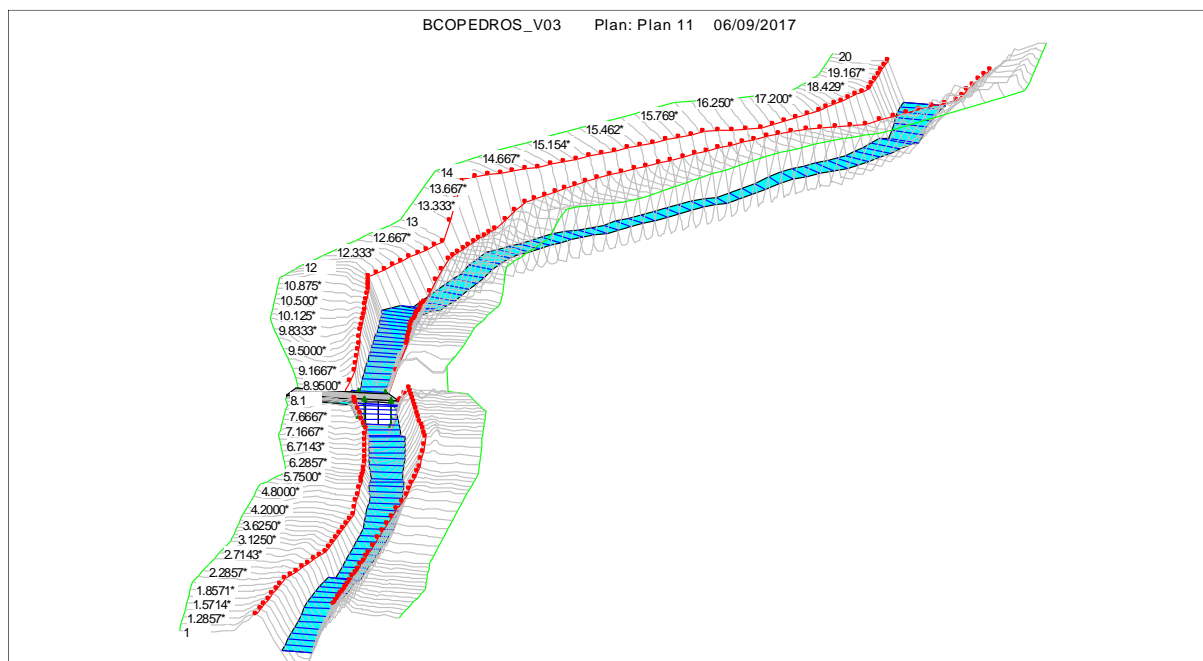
Vista 3D de las secciones utilizadas encauzamiento previsto.
